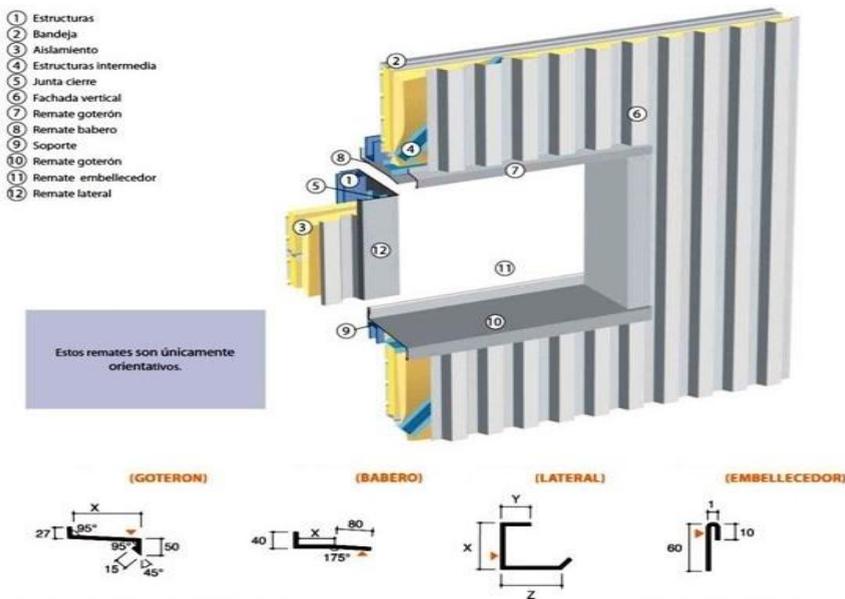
Subestructura con bandejas metálicas (Fuente:www.linagar.com)
